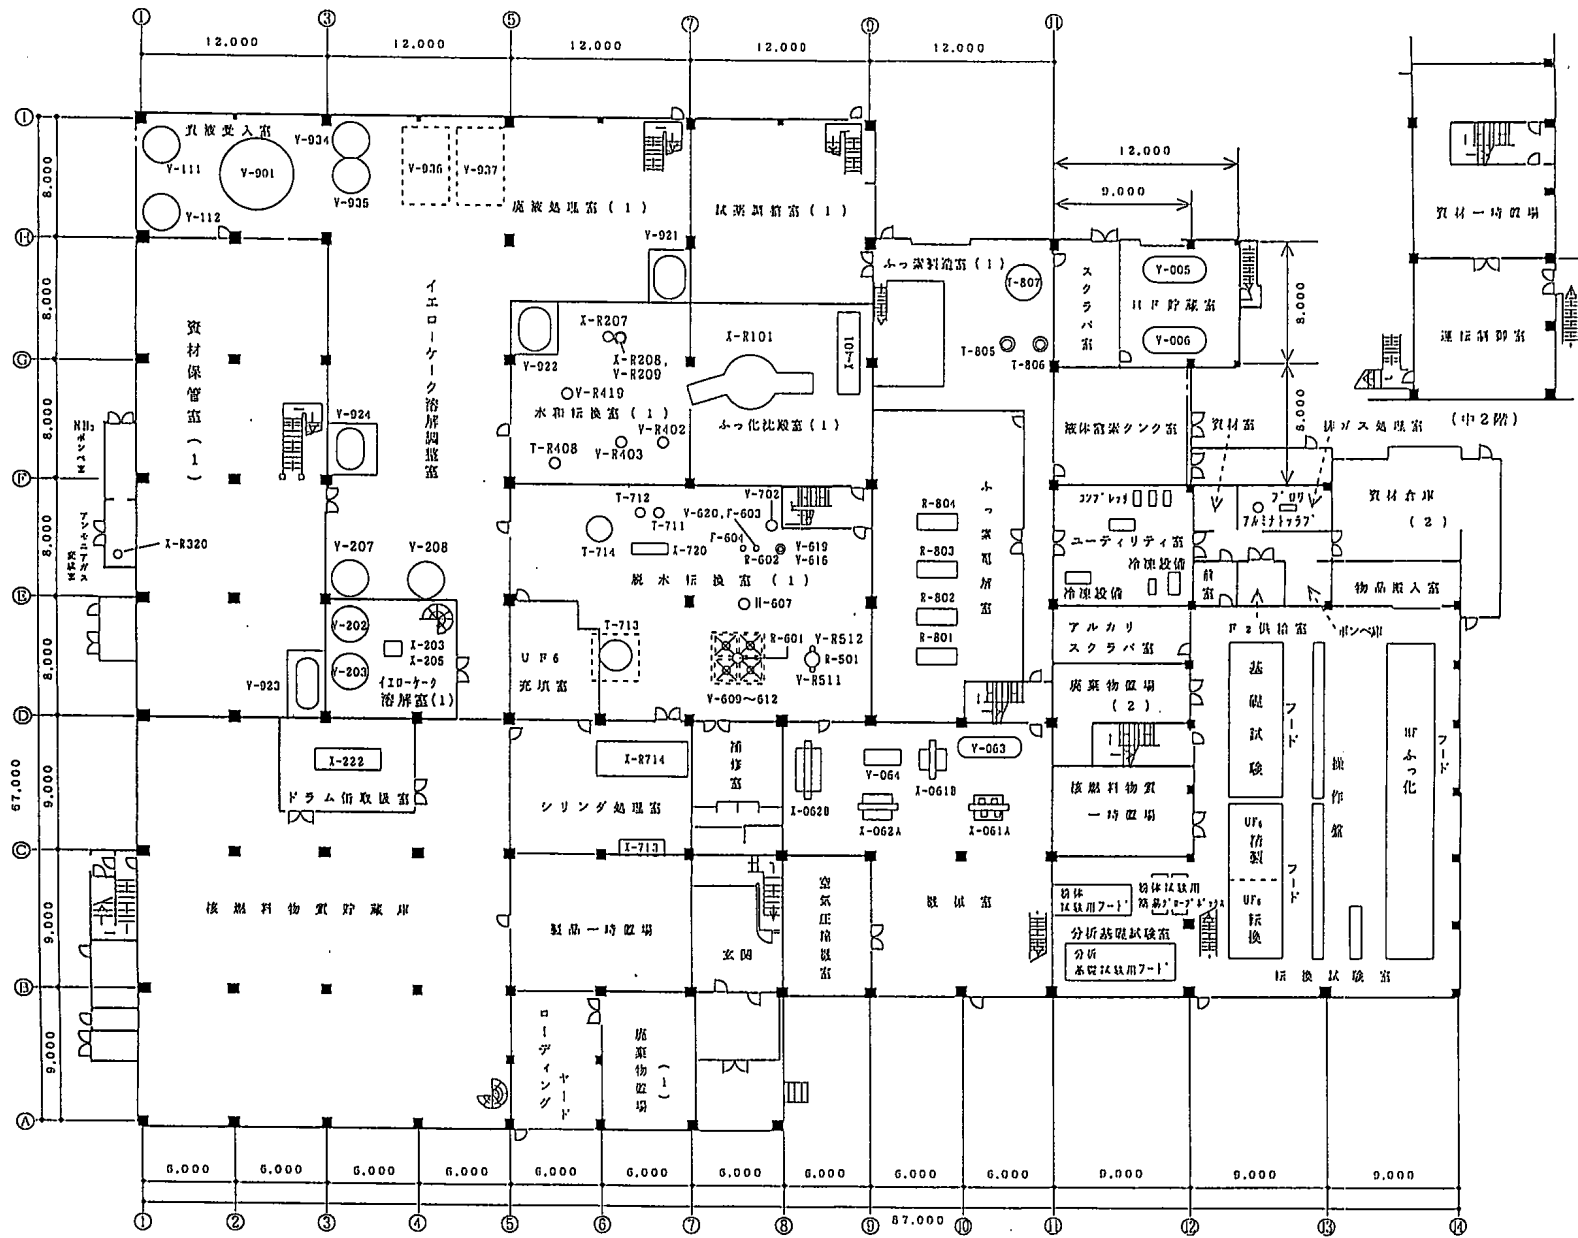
製鍊転換施設主要機器配置平面図 (1階)
